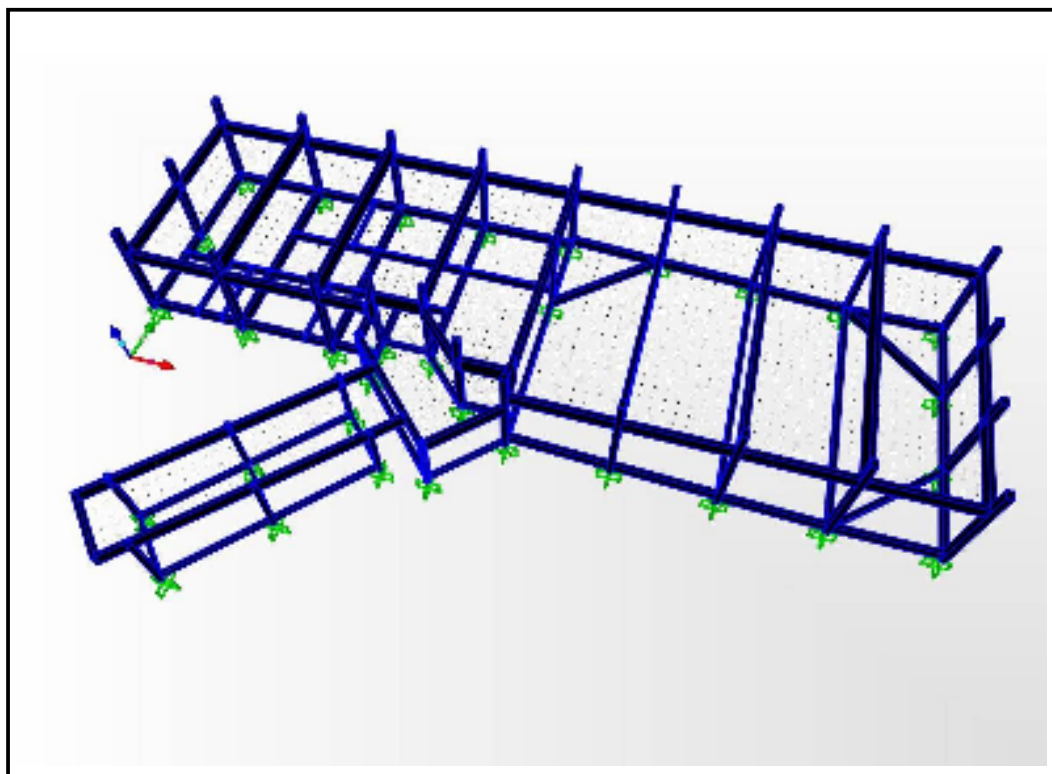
Vista em perspectiva noroeste do modelo estrutural apresentando somente os elementos de barra
